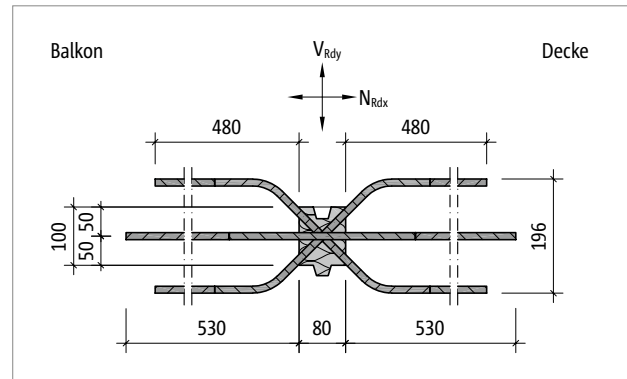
Schöck Isokorb® T Typ H-VV2-NN1: Produktgrundriss
